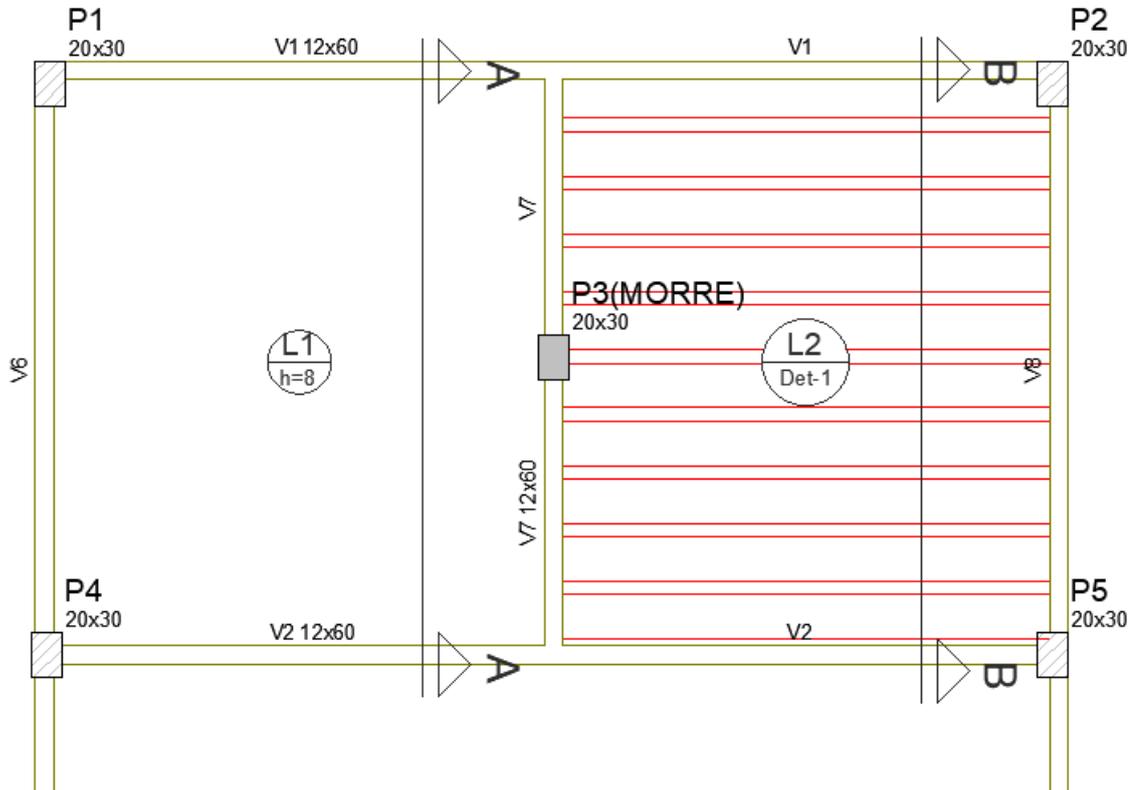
Detalhe da planta de cofragem fornecida pelo Software
